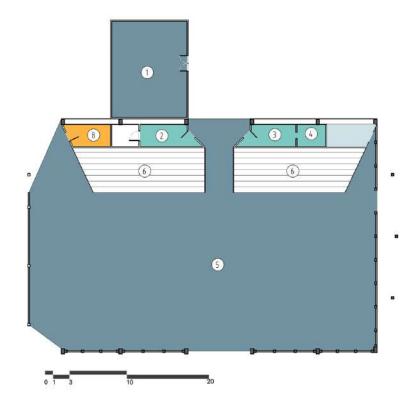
Planta 1 Bloque 37. Fuente: Equipo de diagnóstico.
